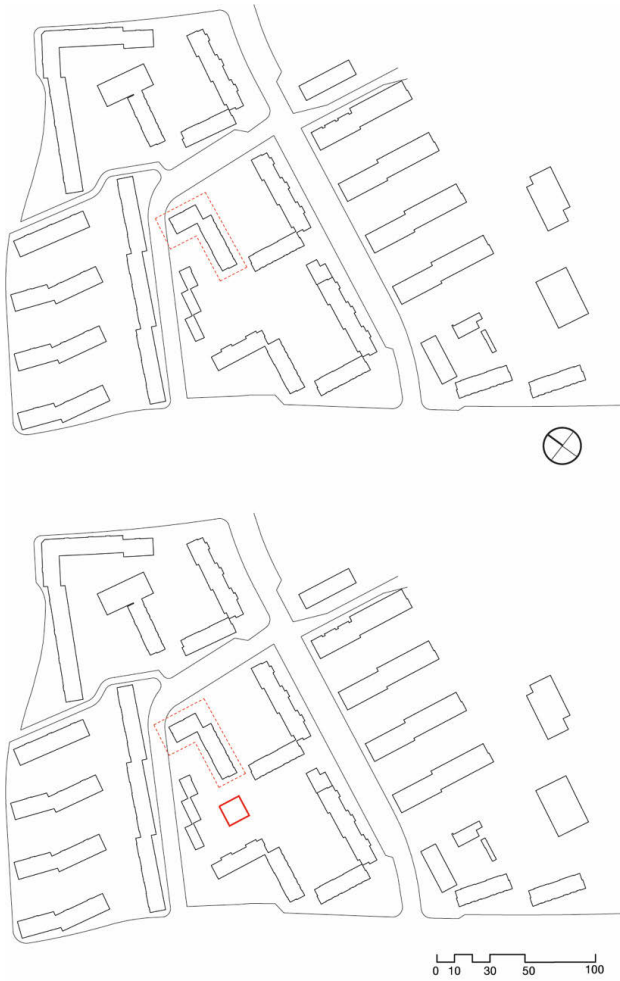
Lagepläne Nachverdichtung, Bremer Punkt 3
